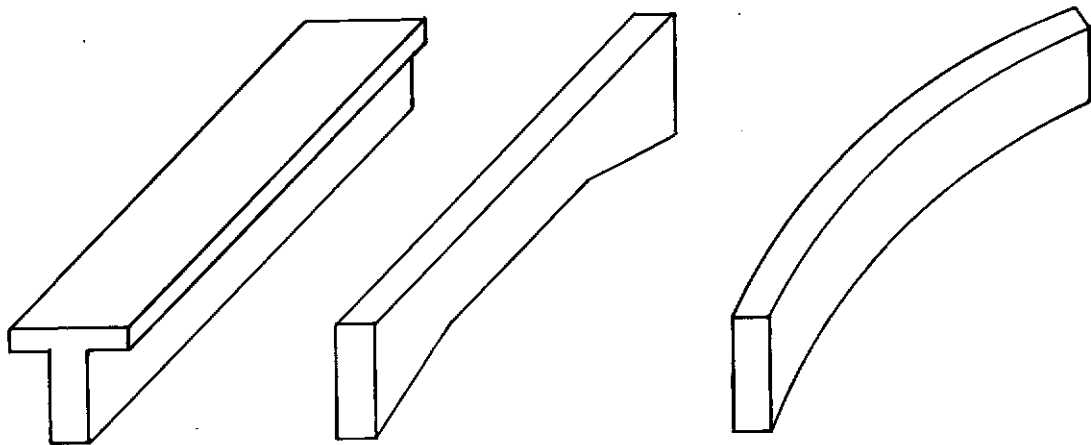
Laje trabalhando em conjunto com a viga formando uma seção T.
